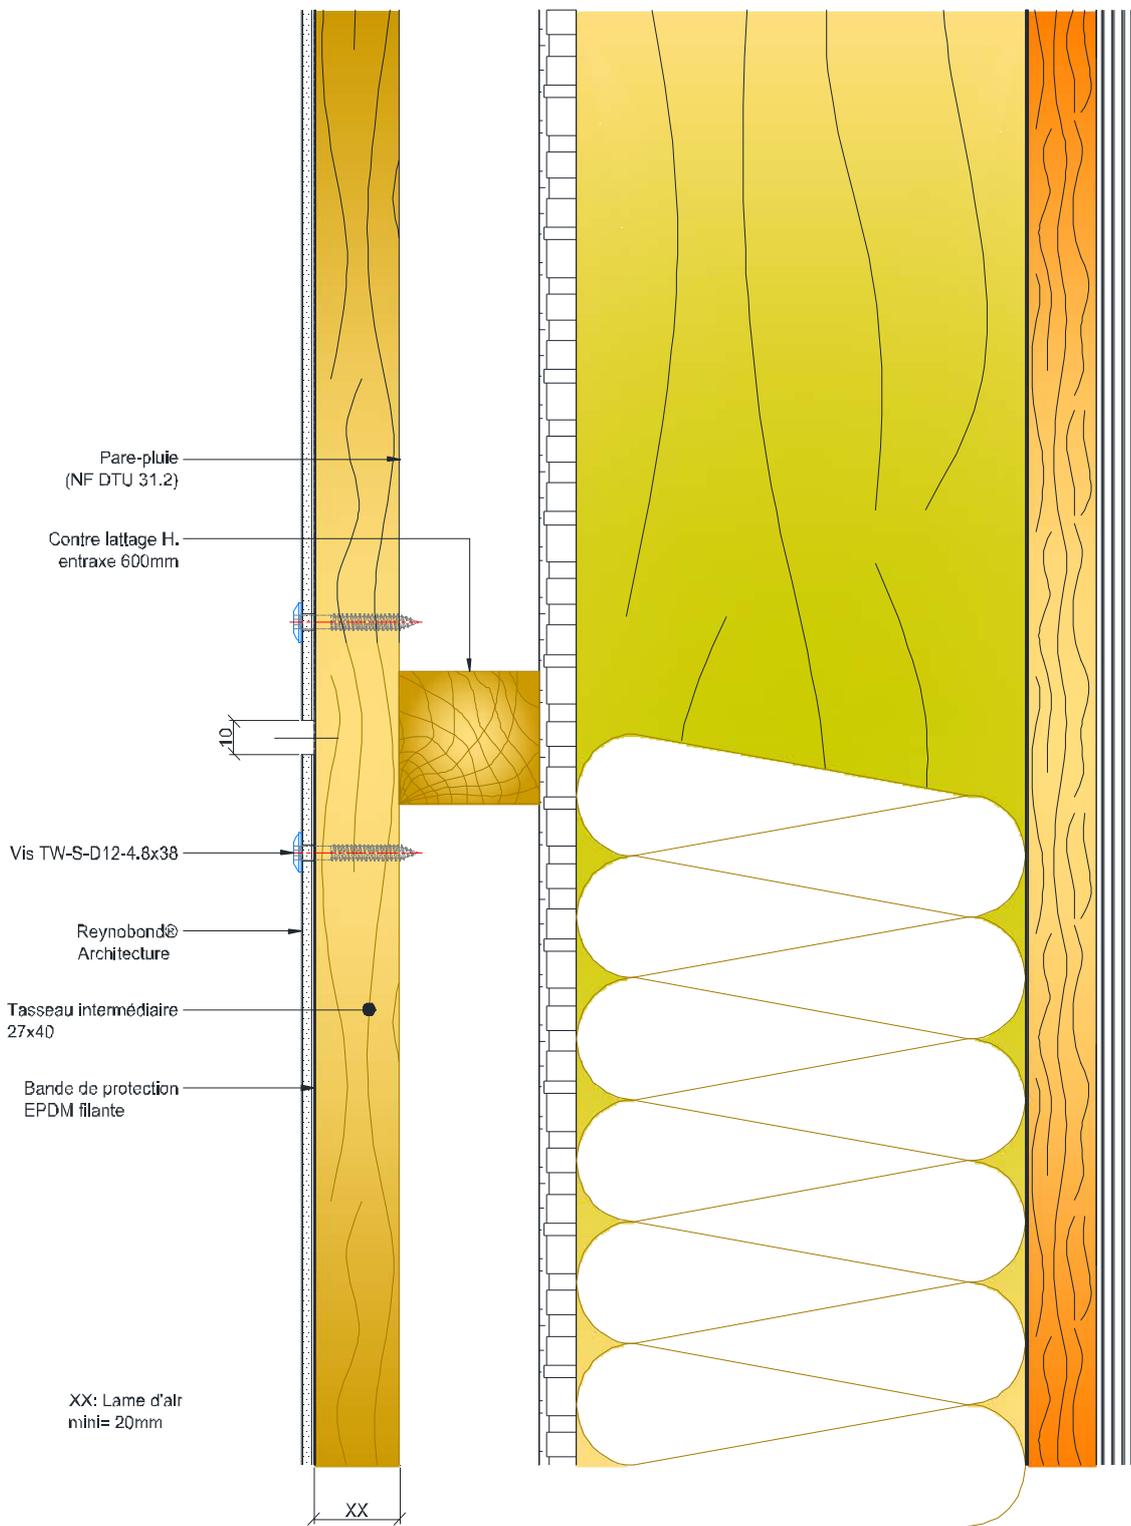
is– Joint horizontal sur COB avec contre-lattage (coupe verticale)
